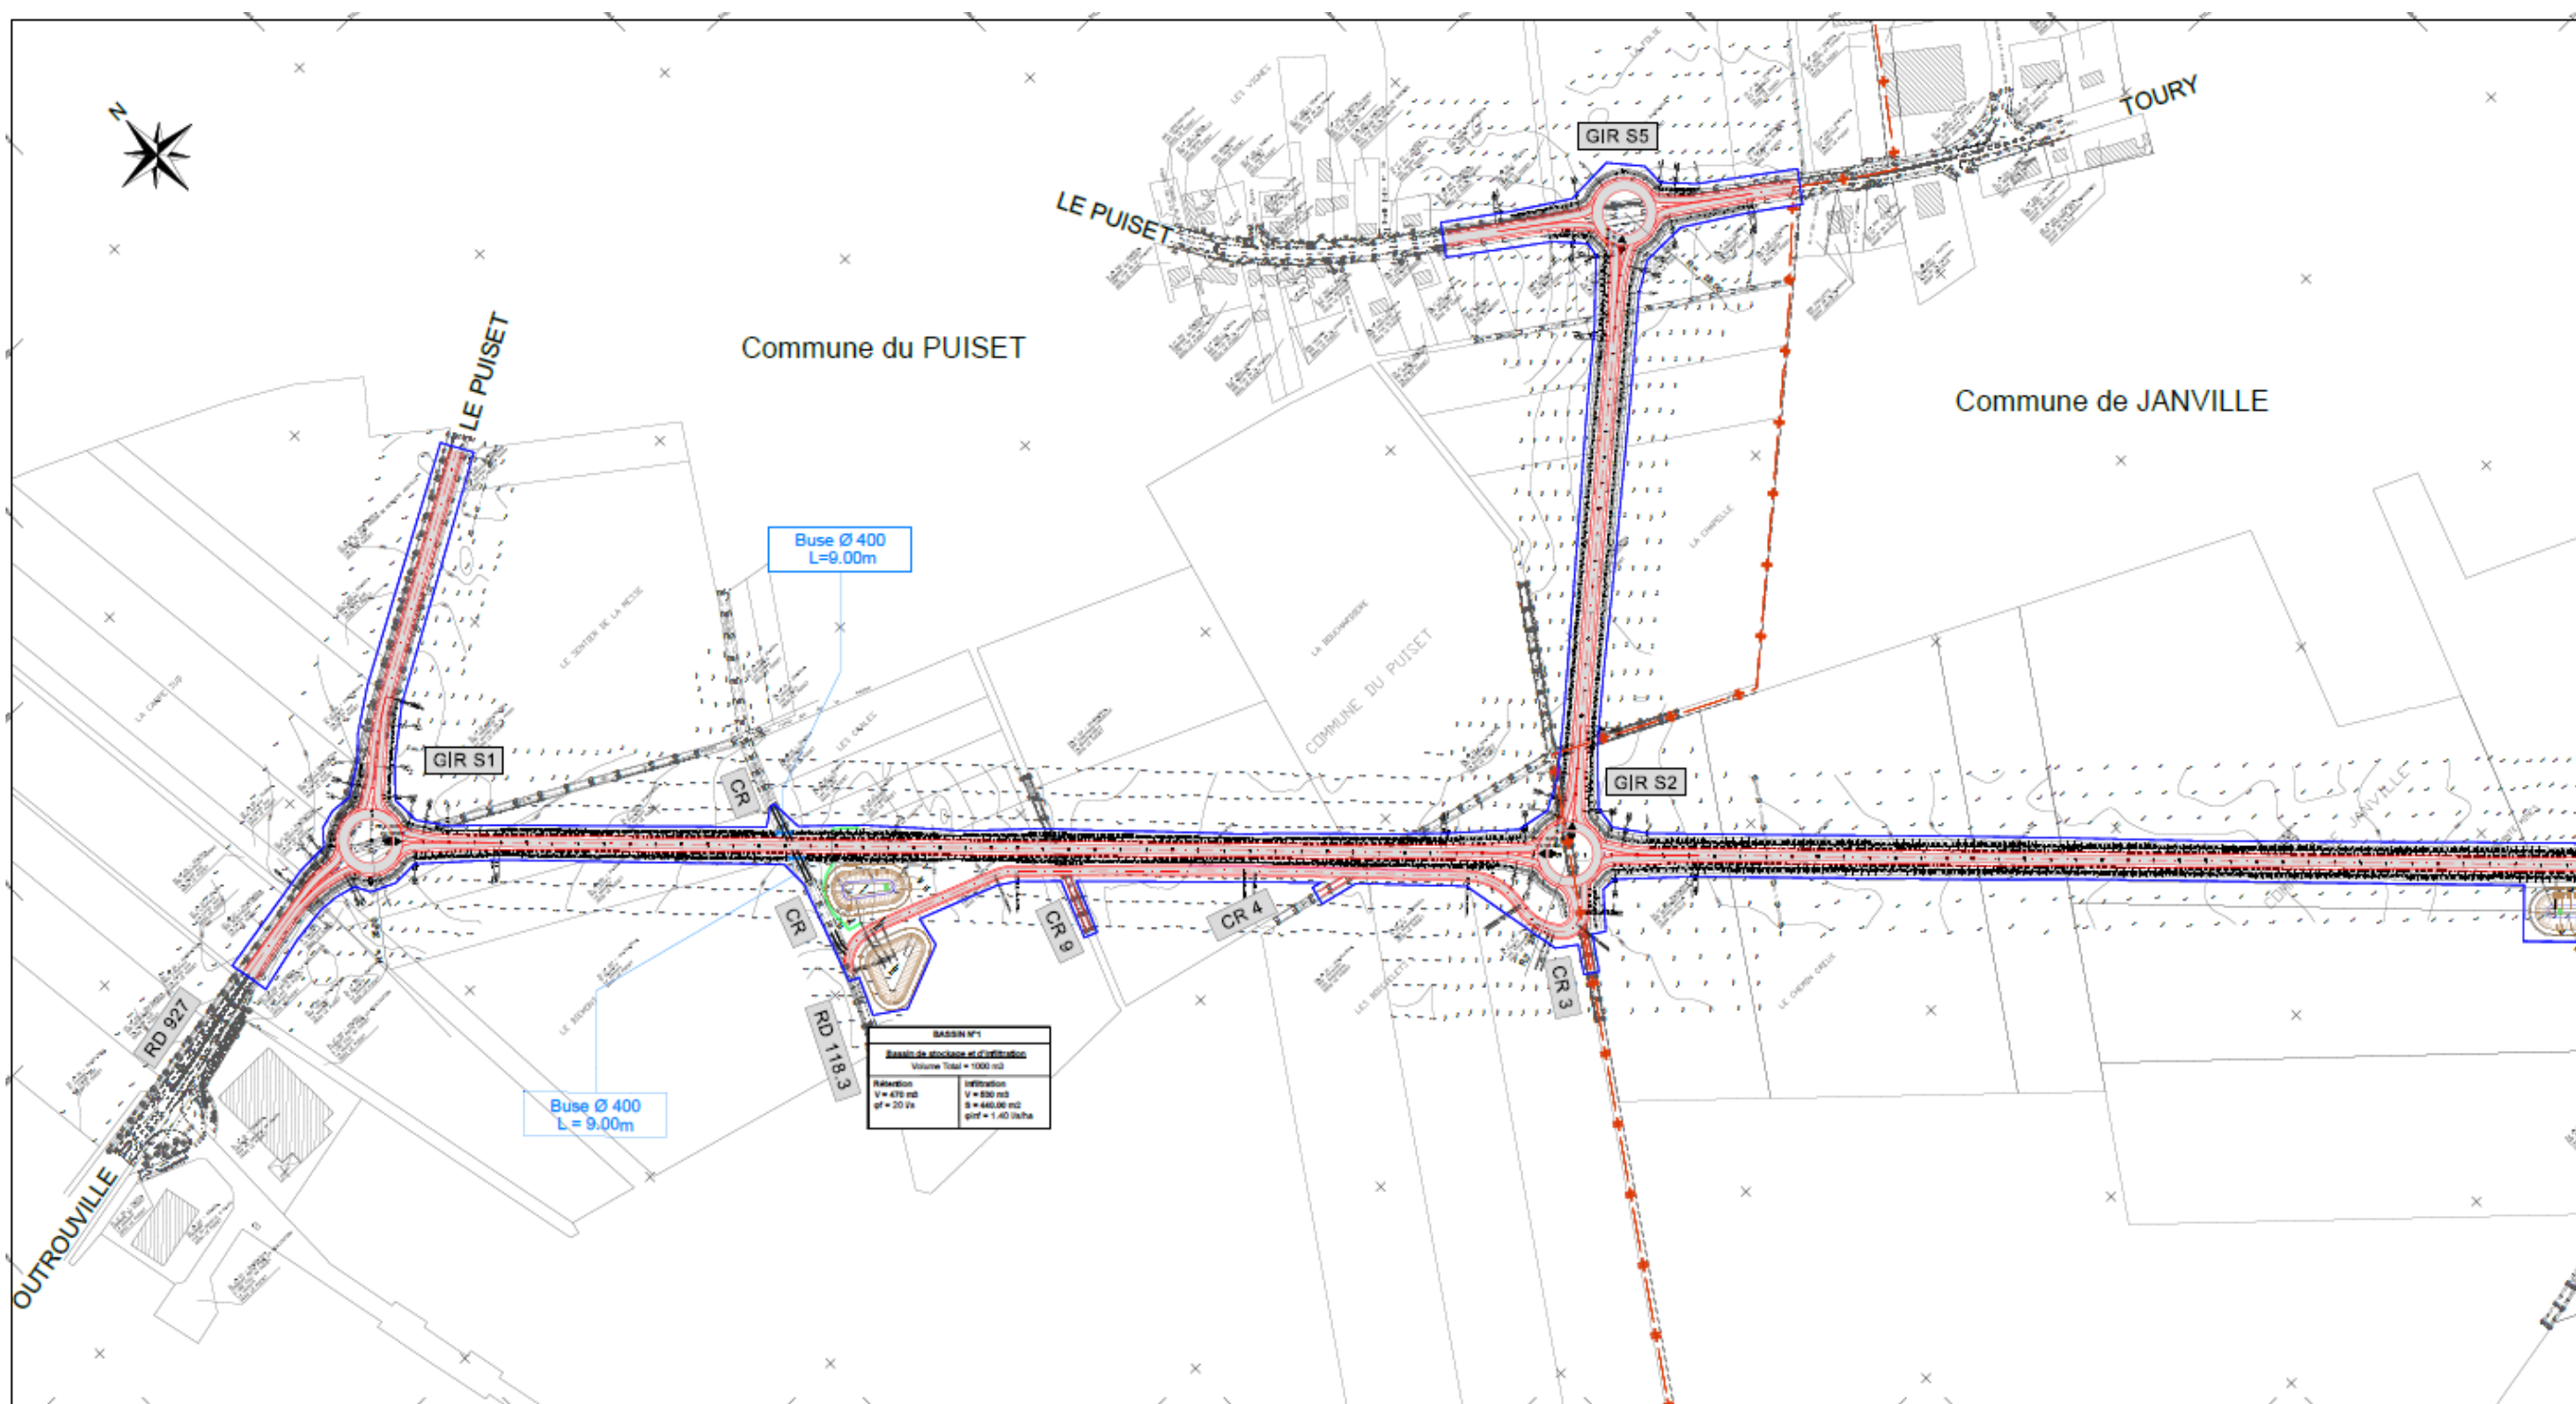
Vue en plan de la déviation de Janville – Le Puset (Planche 1)
